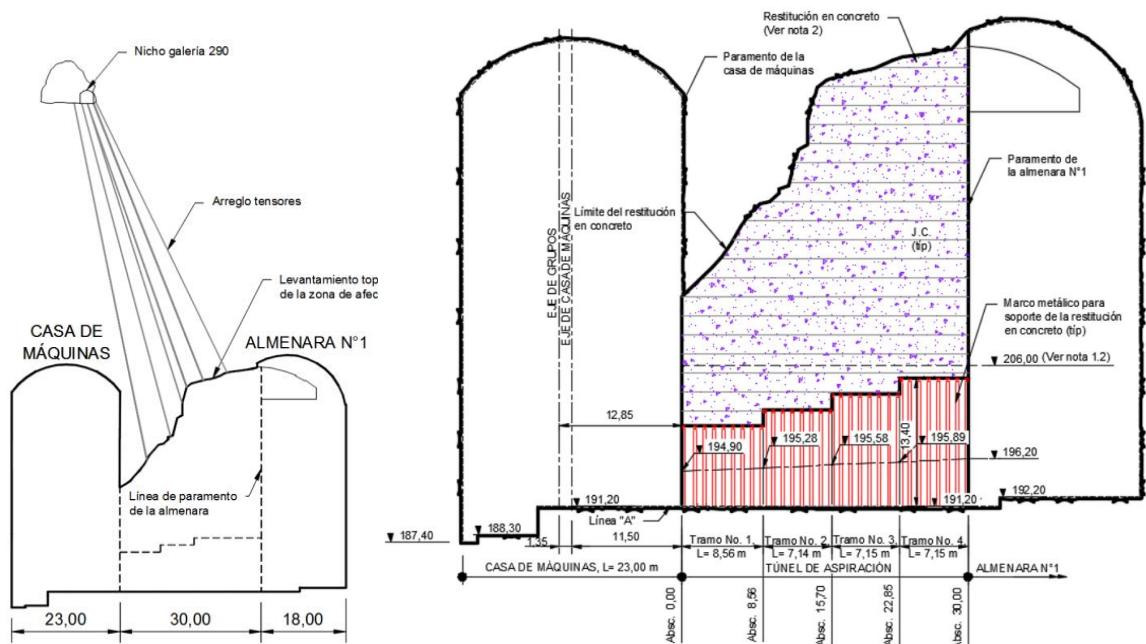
Estabilización del pilar socavado mediante tensores (izquierda) y reconstrucción del pilar (derecha).
